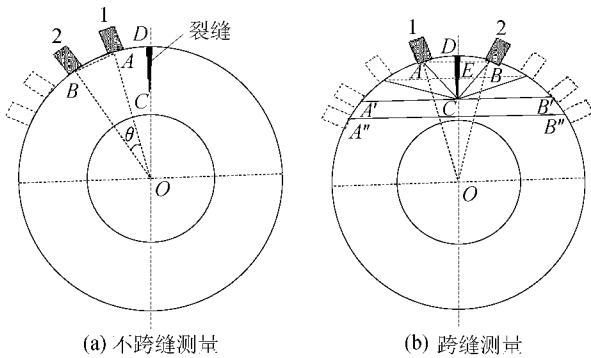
环形混凝土试件纵向裂缝检测示意图
